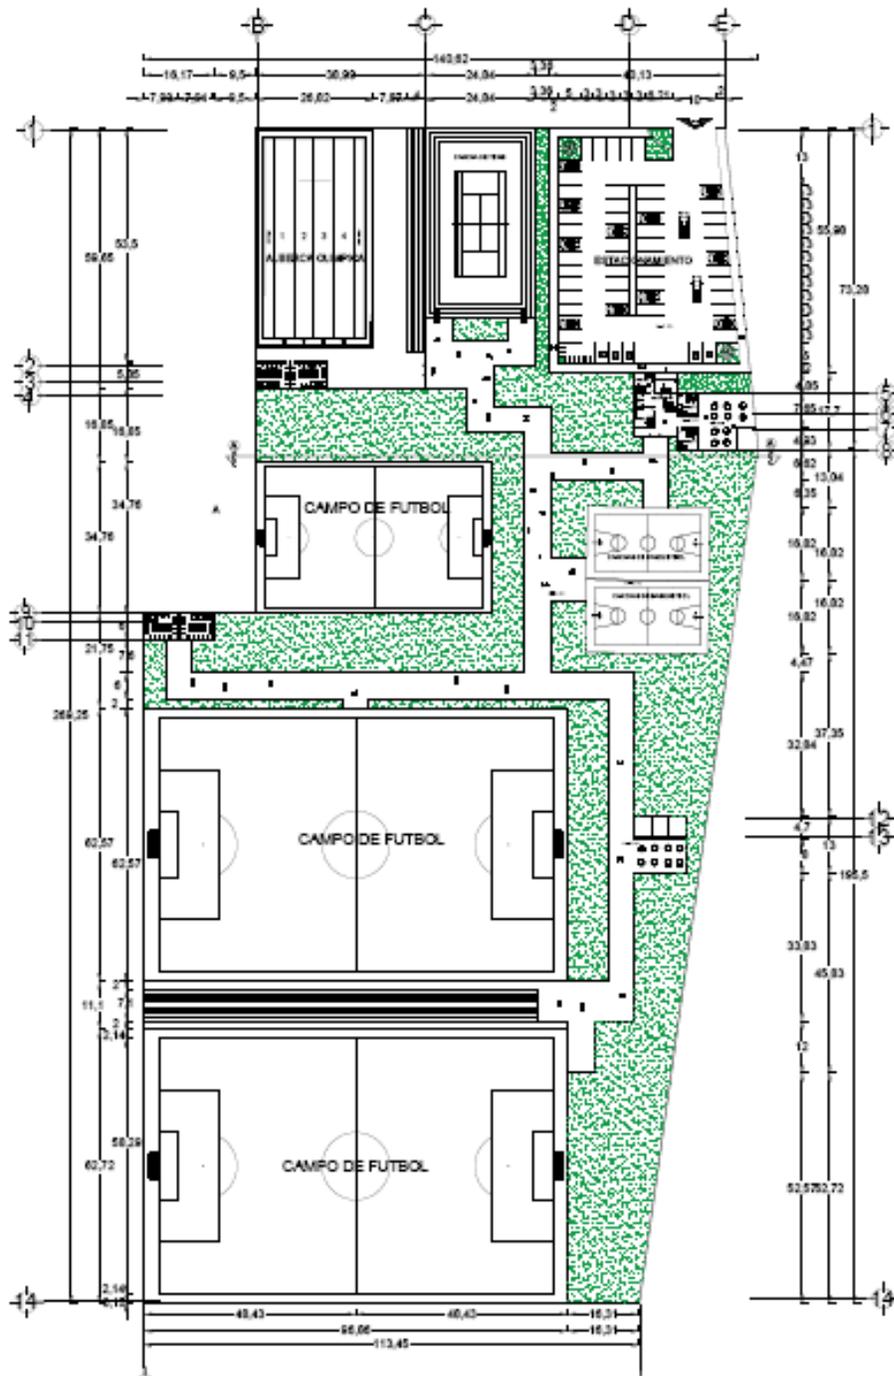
Planta arquitectónica (José Antonio España Reyez)
